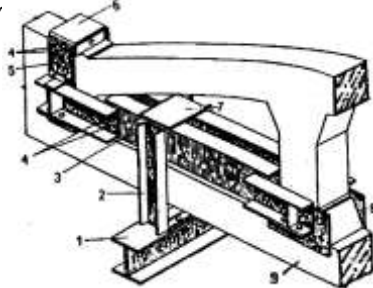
Підвішування кранової рейки до нижнього поясу ферми: 1 – несуча балка підвісного крана; 2 – підвіска; 3 – перекидна балка із двох швелерів; 4
